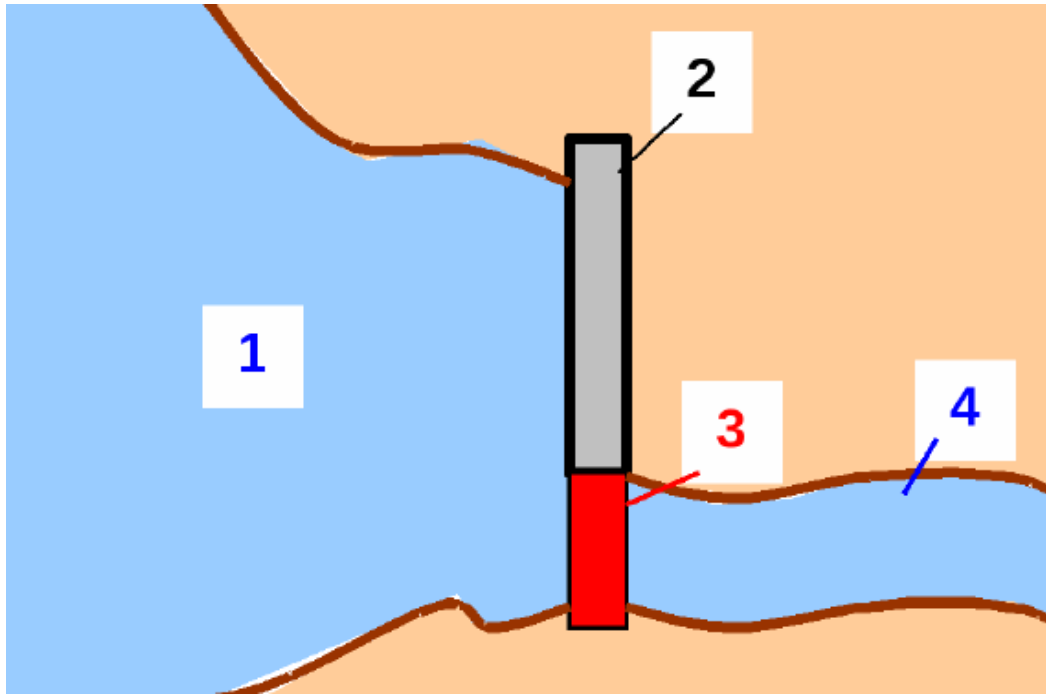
Руслова ГЕС на гірській річці: 1 – водосховище, 2 – земляна (насипна або намивна) гребля, 3 – бетонна (водозливна) гребля і будівля ГЕС, 4 – водоскид
